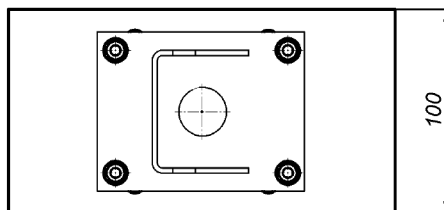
Монтаж кронштейна КС-4 на опору (круглую или квадратную)
